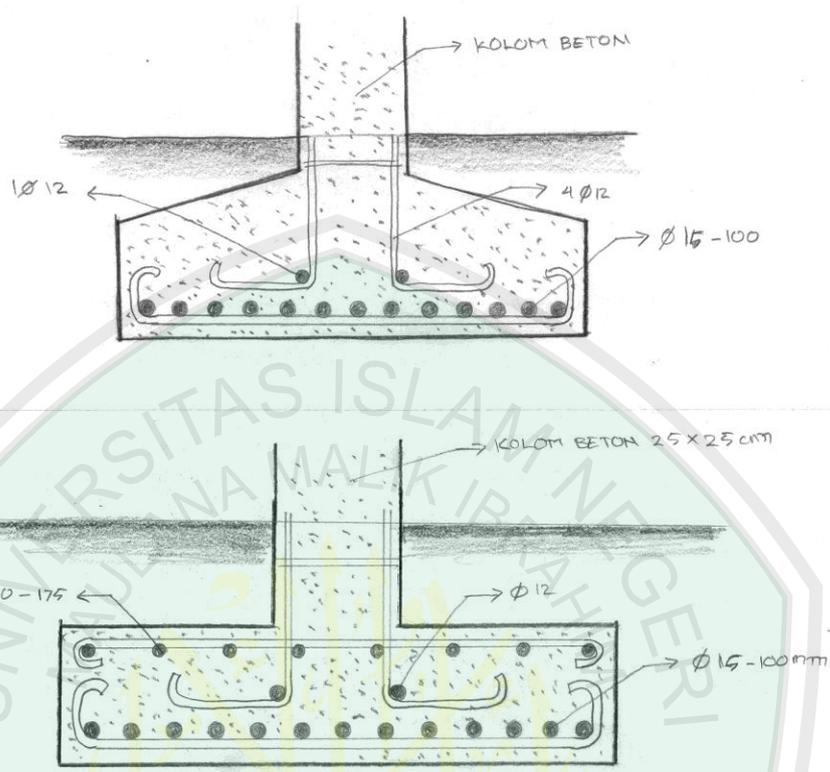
Alternatif 1 Struktur Bawah Bangunan
